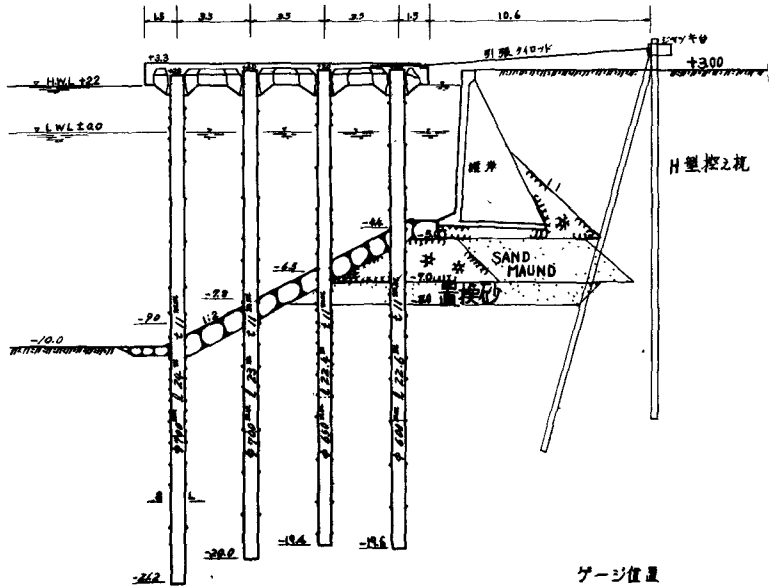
博多港須崎小瀬-10m岸壁水平載荷試験断面図及びゲージ貼付位置
